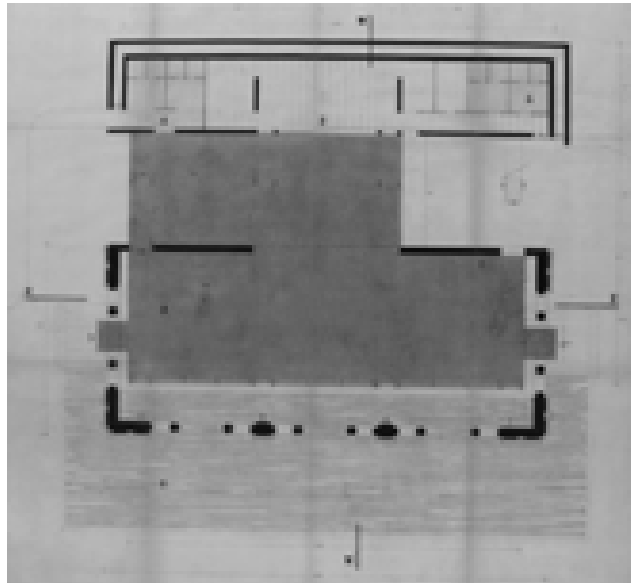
Pianta del piano terra, progetto di massima, 1973/1974 (AABS-160)
